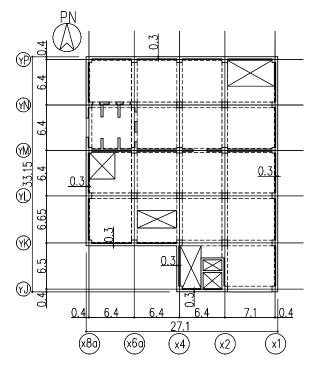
地上2階平面図 (G.L.+4.7) (単位:m)
